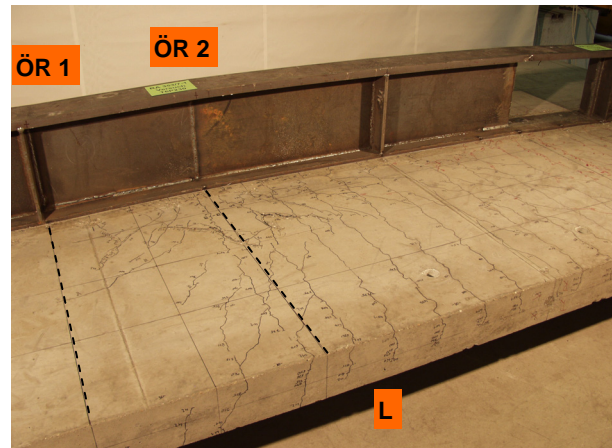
Rissbild auf der linken Betongurtseite
